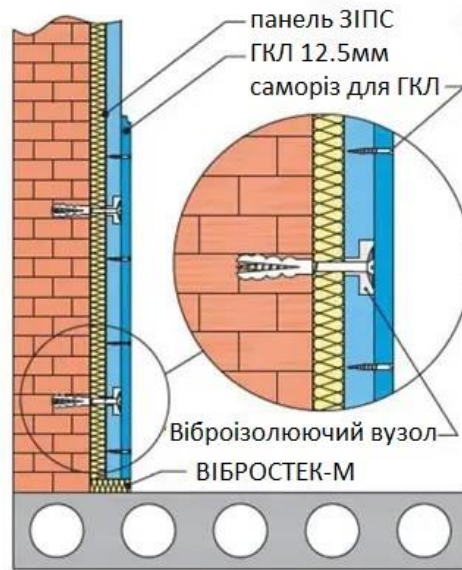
Схема монтажу ЗПС панелей на стіну
